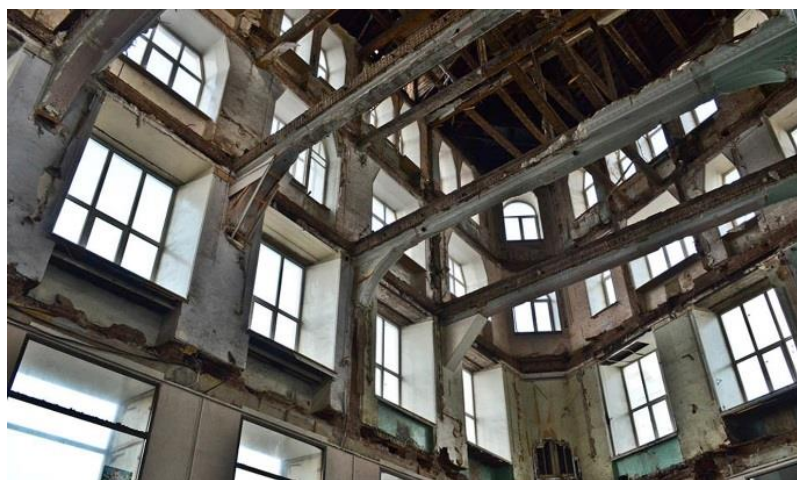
Загальний вигляд будівлі після демонтажу дерев'яних плит перекриття
